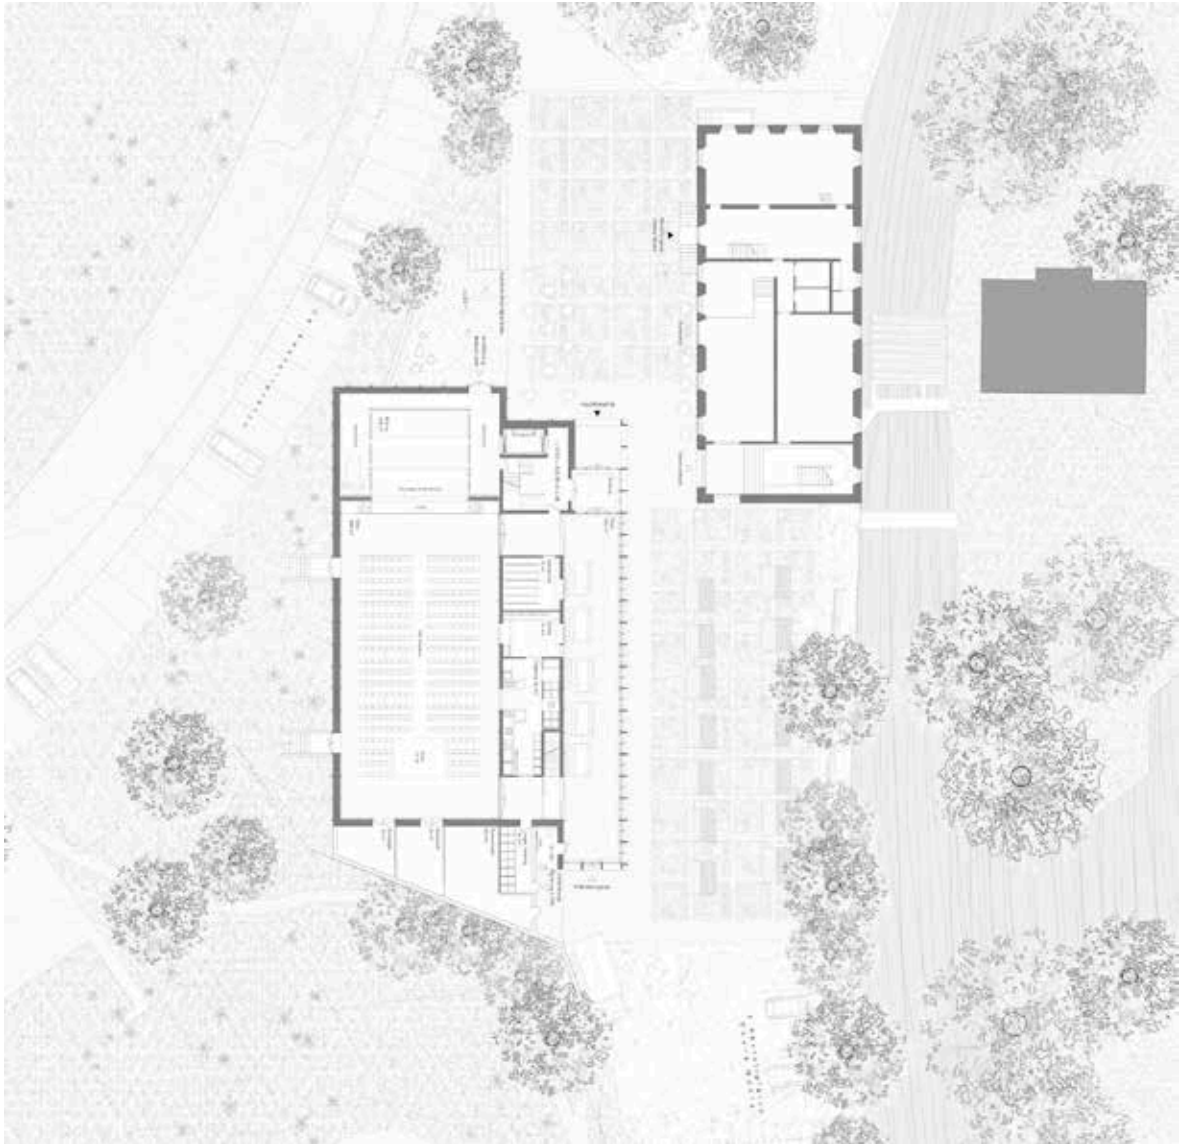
Grundriss Erdgeschoss o.M.
